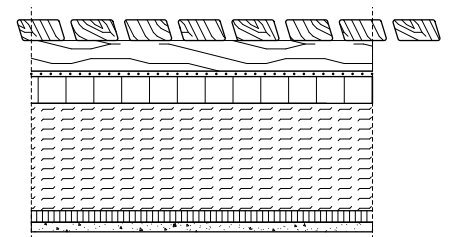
Ausführung einer Fassade mit offenen Fugen auf senkrechter Lattung. Eine UV-beständige und diffusionsoffene Fassadenbahn (1) ist erforderlich.
